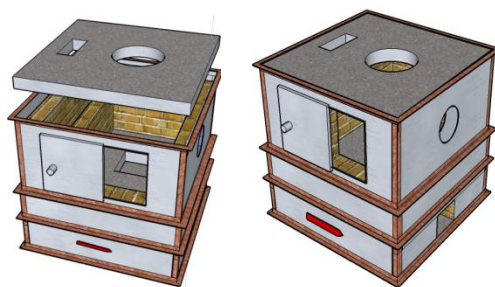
Módulo 3 ou câmara de combustão, recebendo a laje e pronto para receber o módulo 4 ou câmara de resfriamento da base do depósito de carvão.
